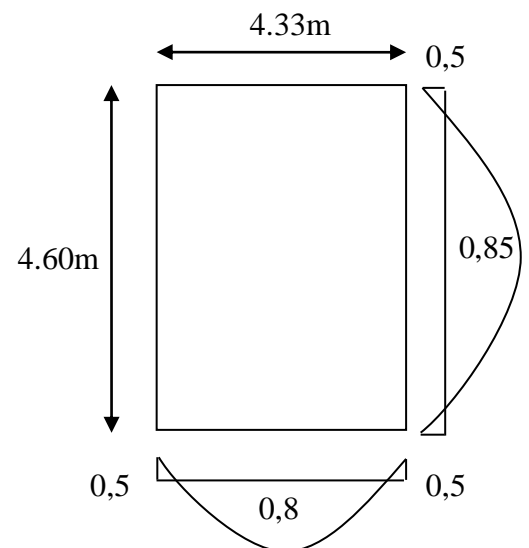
Dimensions du panneau de dalle la plus sollicité
